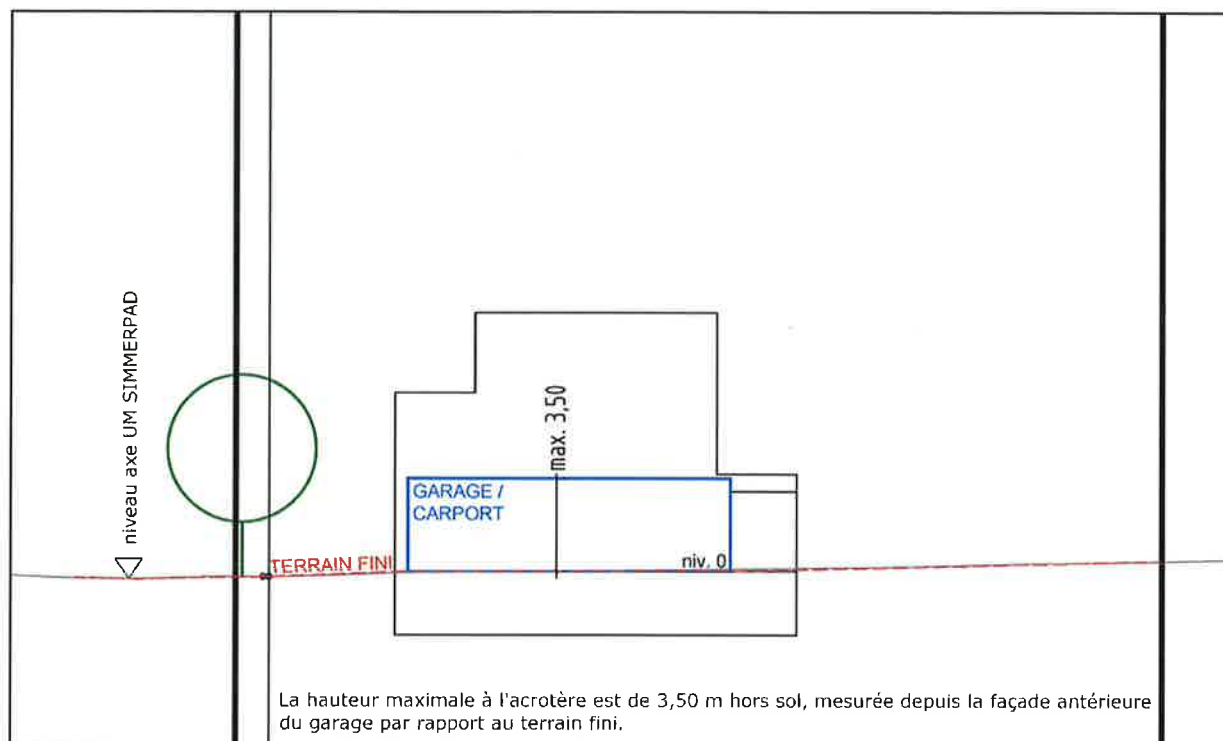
Croquis explicatif pour la définition de la hauteur à l'acrotère des garages/carports
